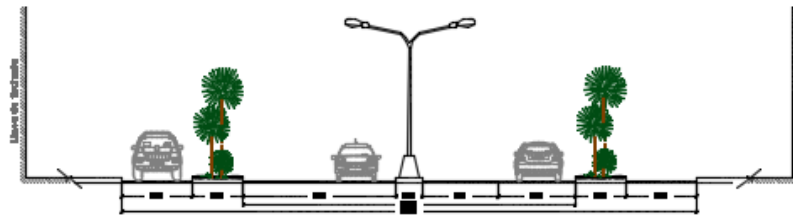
Propuesta Perfil Avenida Carubana, Carretera - 1 (2018)
